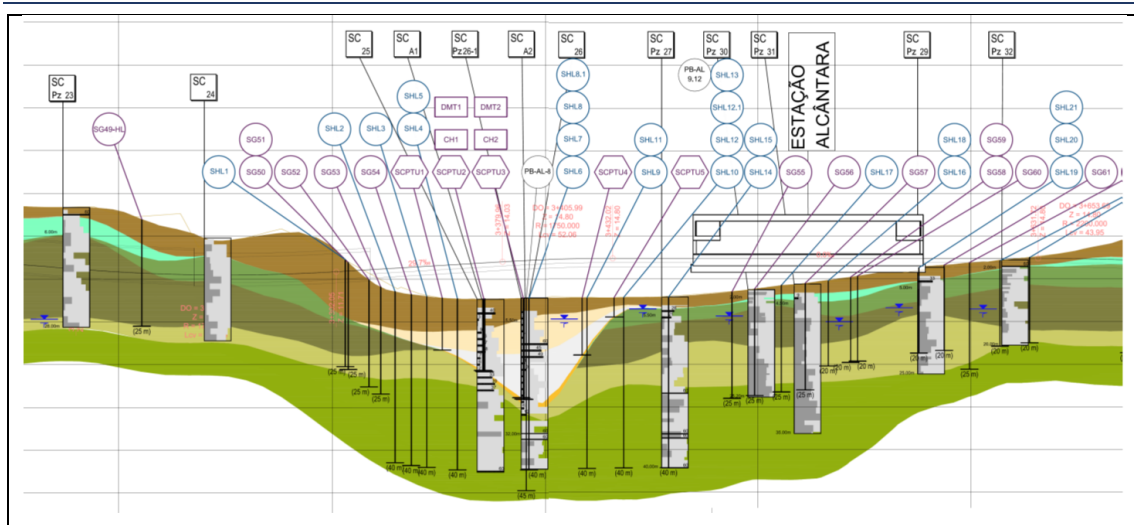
Planta e perfil longitudinal – Geologia / Geotecnia
